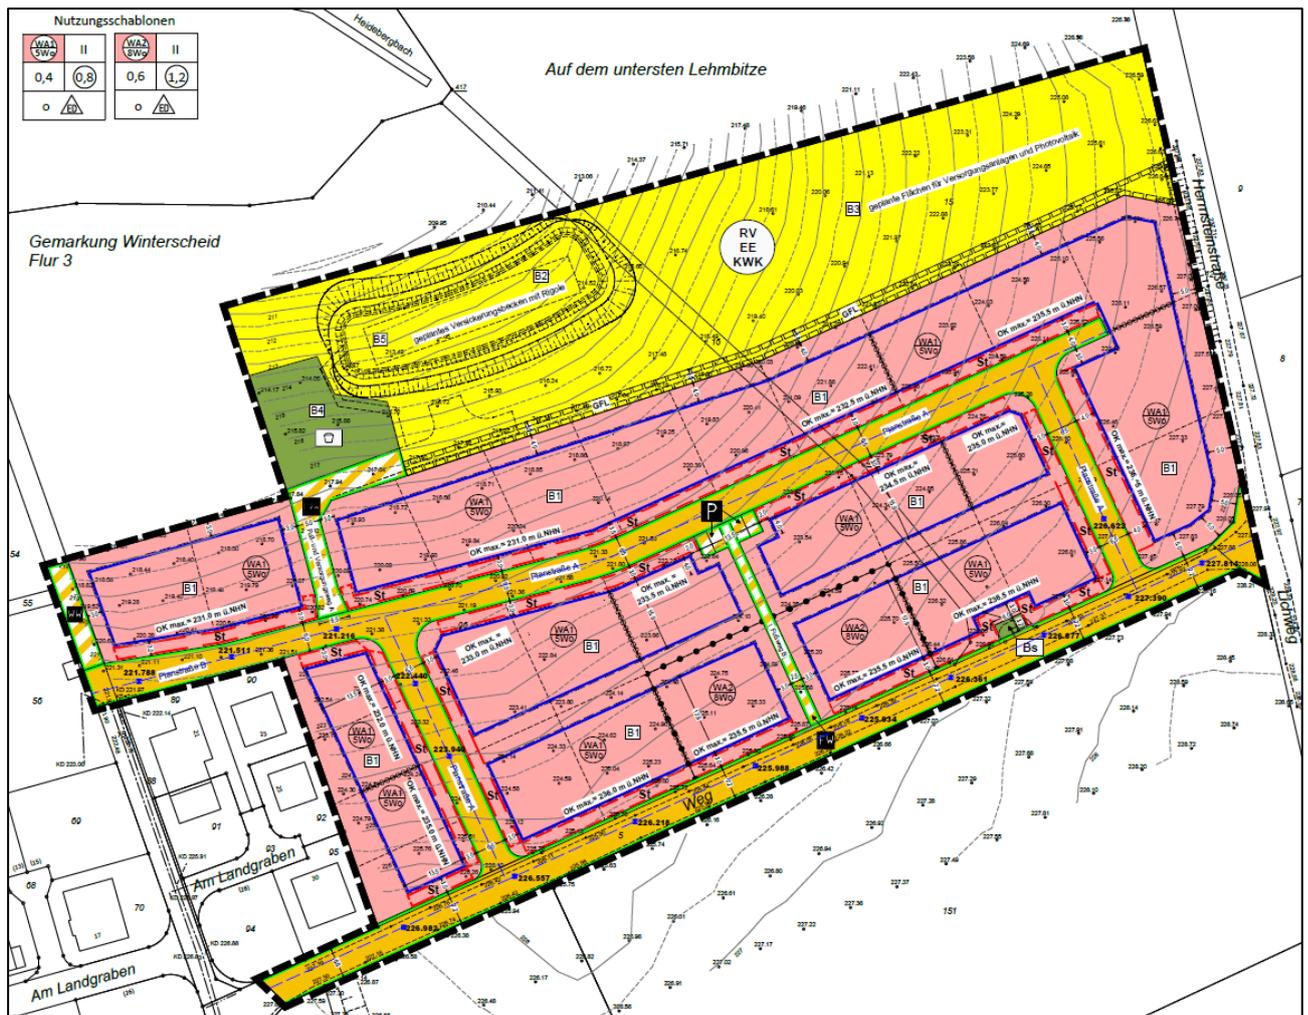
Planzeichnung Bebauungsplan, Quelle: HKS, 2024
